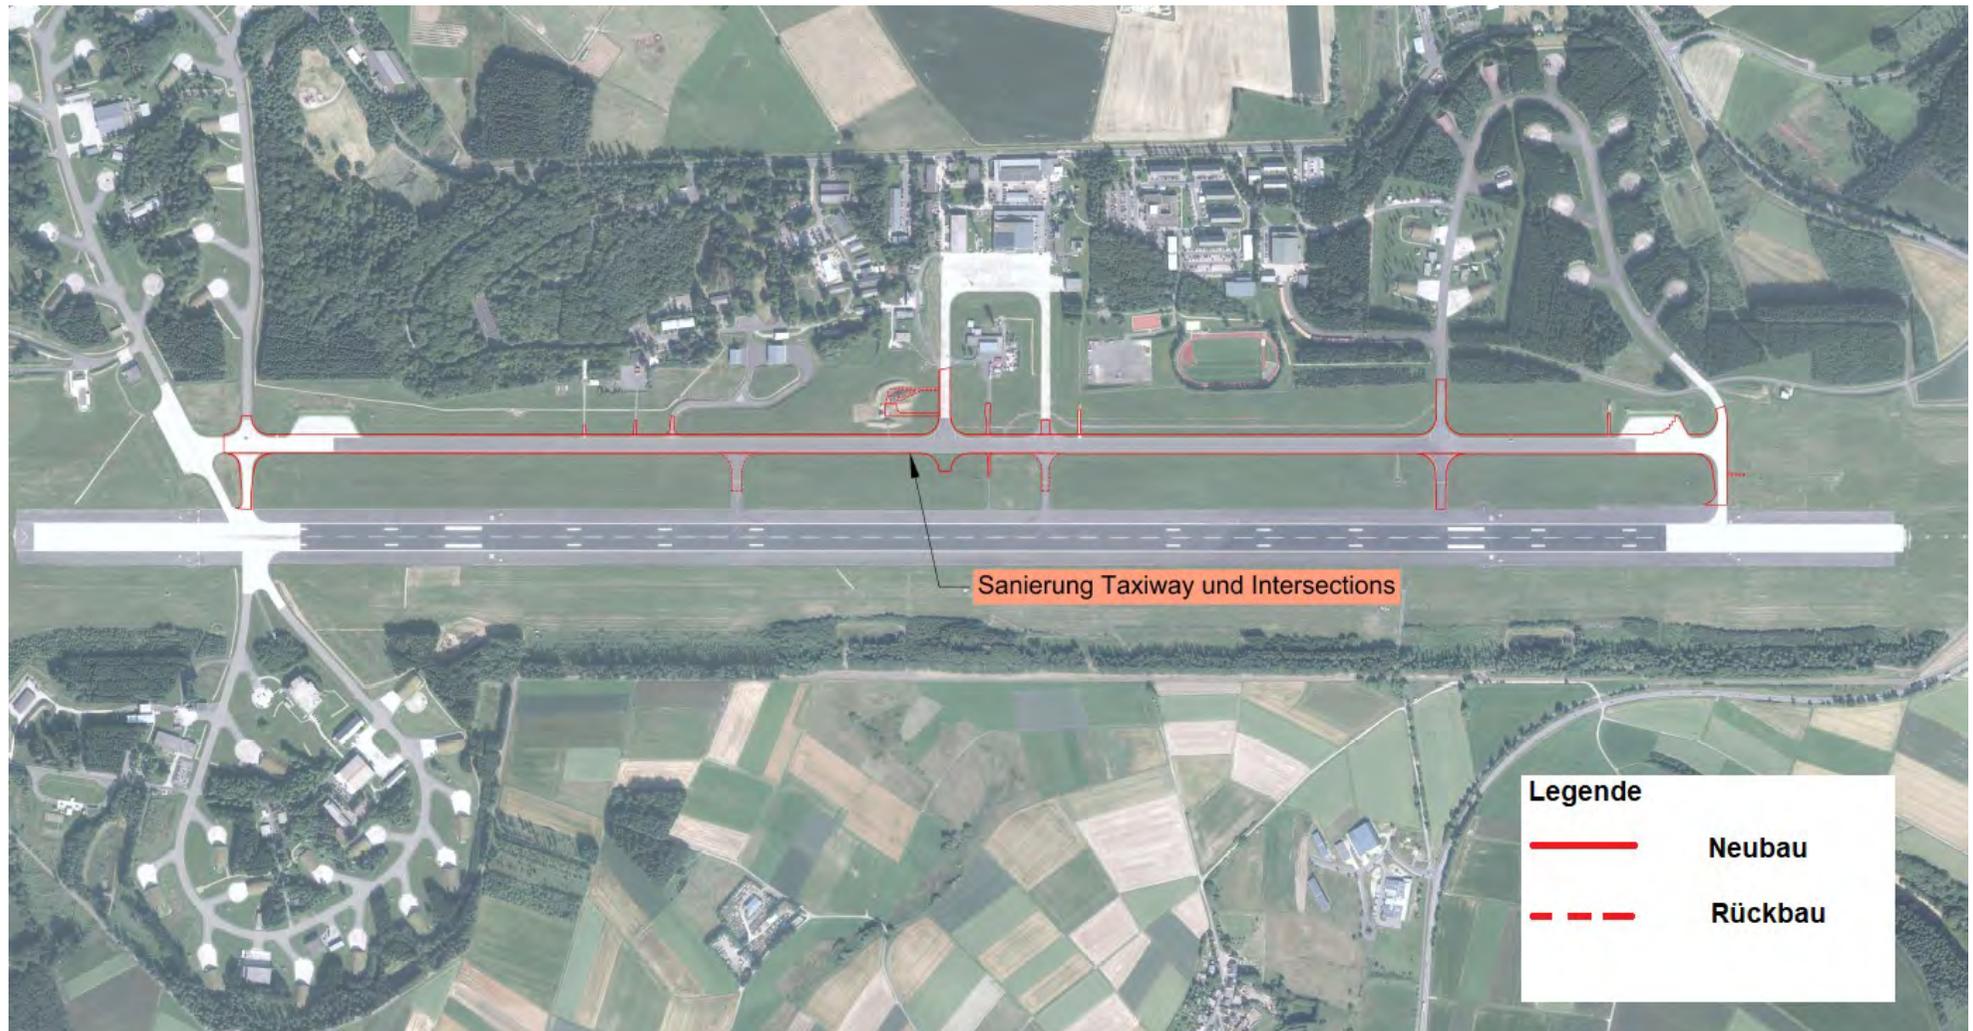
Ausschnitt Übersichtslageplan Luftbild mit Darstellung der Ausbauflächen von Rollbahn, Intersections und Angleichung seitlicher Zuwegungen „Sanierung Taxiway und Intersections“ NATO-Flugplatz Büchel
